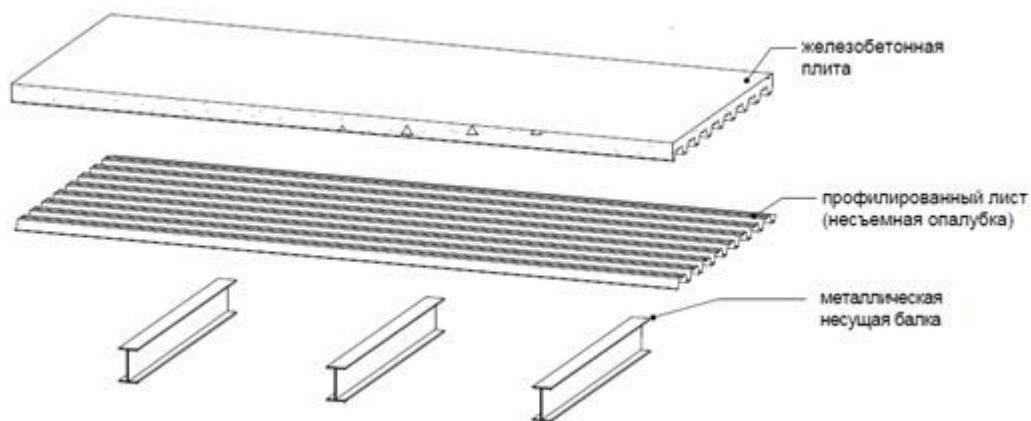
Перекрытие по металлическим балкам с использованием профилированного листа в качестве несъемной опалубки
